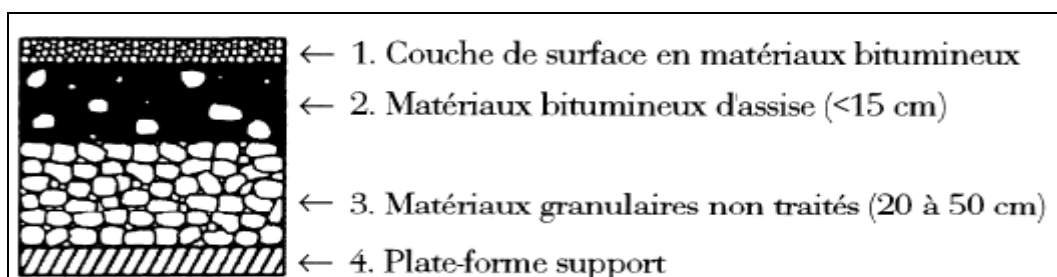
Chaussée souple [catalogue des chaussées, 1998]
